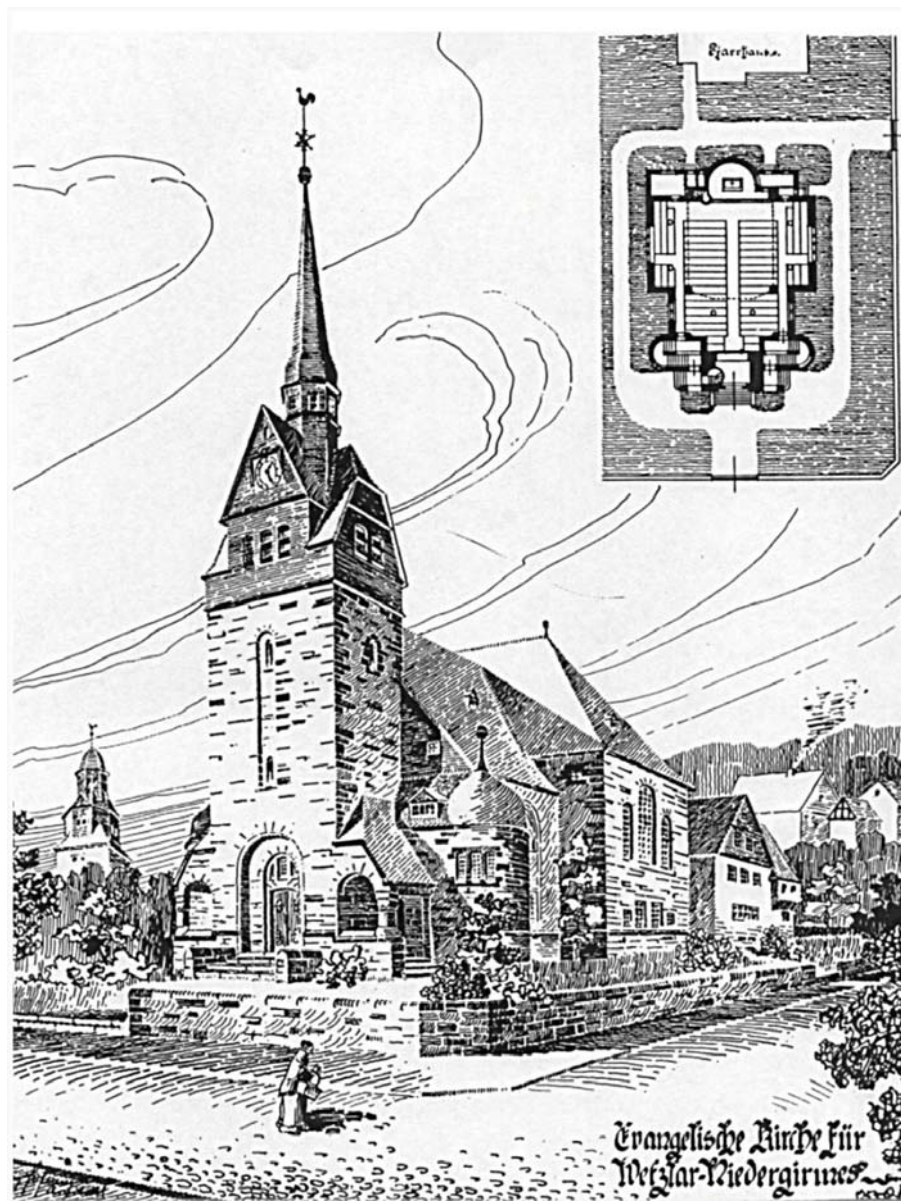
Lageplan, Grundriss Erdgeschoss und Außenansicht, Entwurf Ludwig Hofmann
